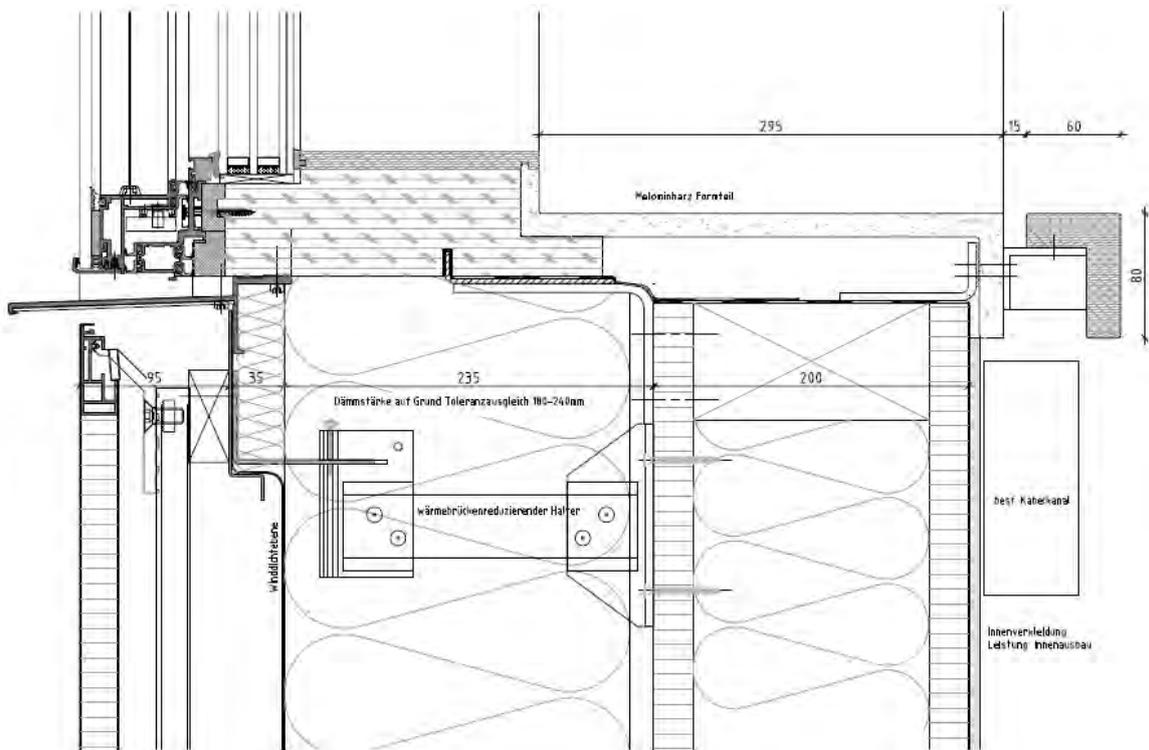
Fassadendetailschnitt; Holz-Alu Fassade (Quelle: ATP architekten ingenieure)
